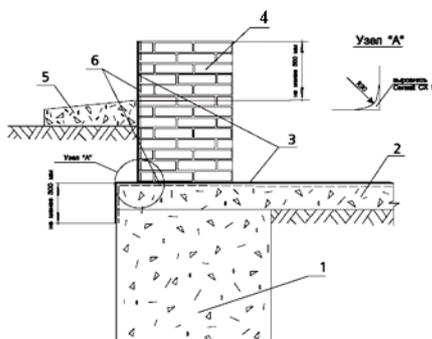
Устройство гидроизоляции фундаментов и стен подвалов.
